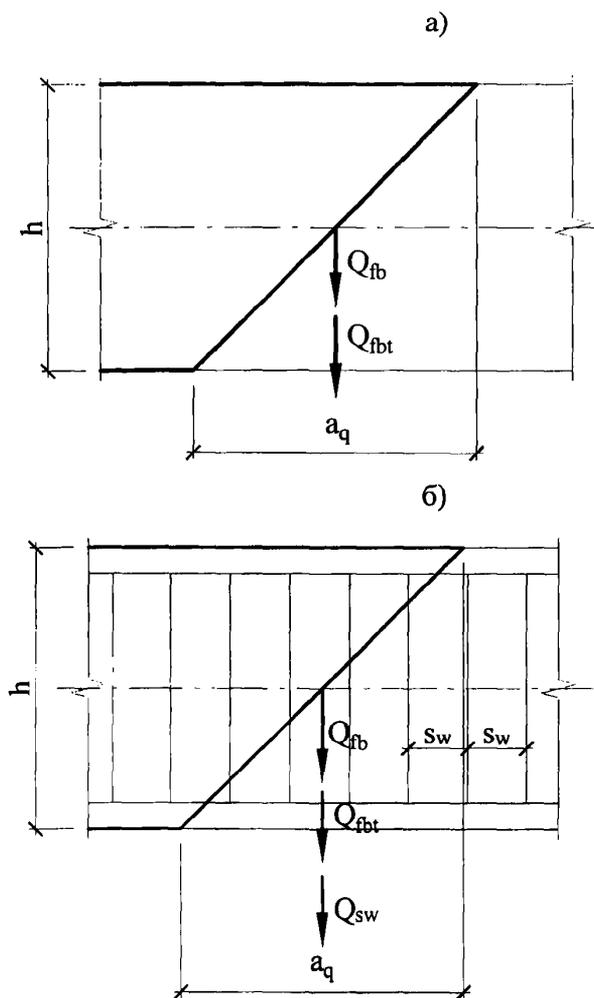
Схема усилий при расчете сталефибробетонных элементов по наклонному сечению на действие поперечных сил:
